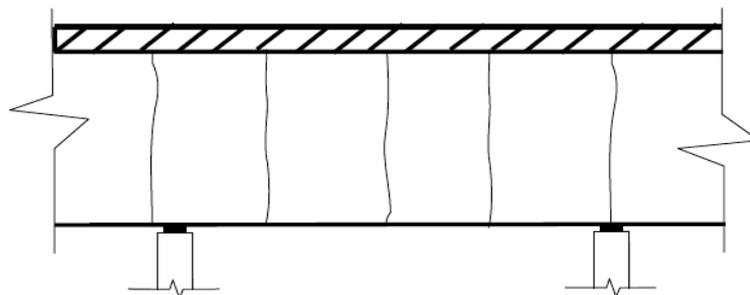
Configuração da fissuração por retração térmica
